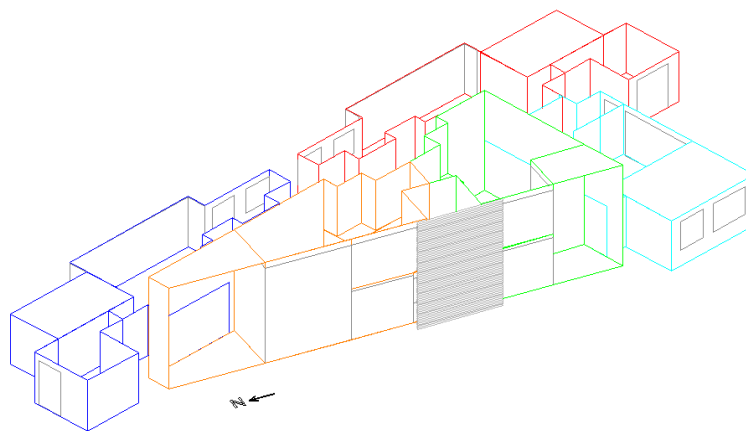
Vista em perspectiva das zonas térmicas do pavimento tipo
